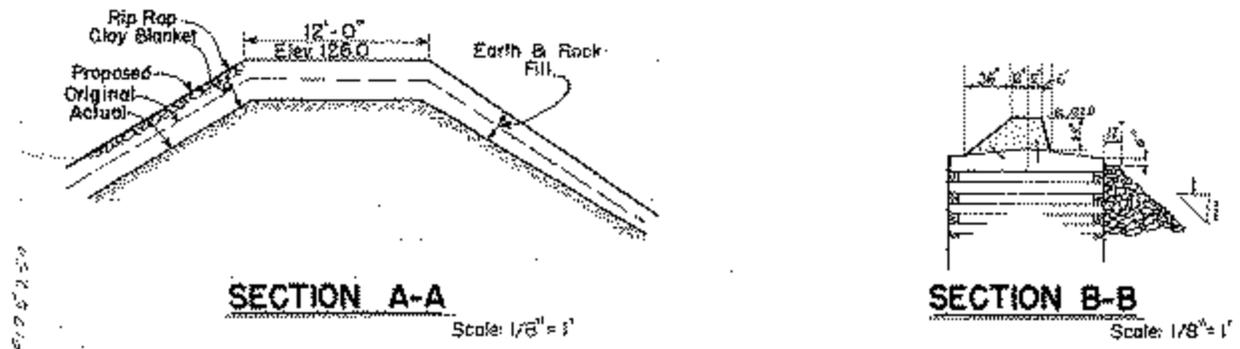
STRCT1 – Coupe type du rehaussement du seuil déversant en béton et de l'ouvrage en remblai en 1946
